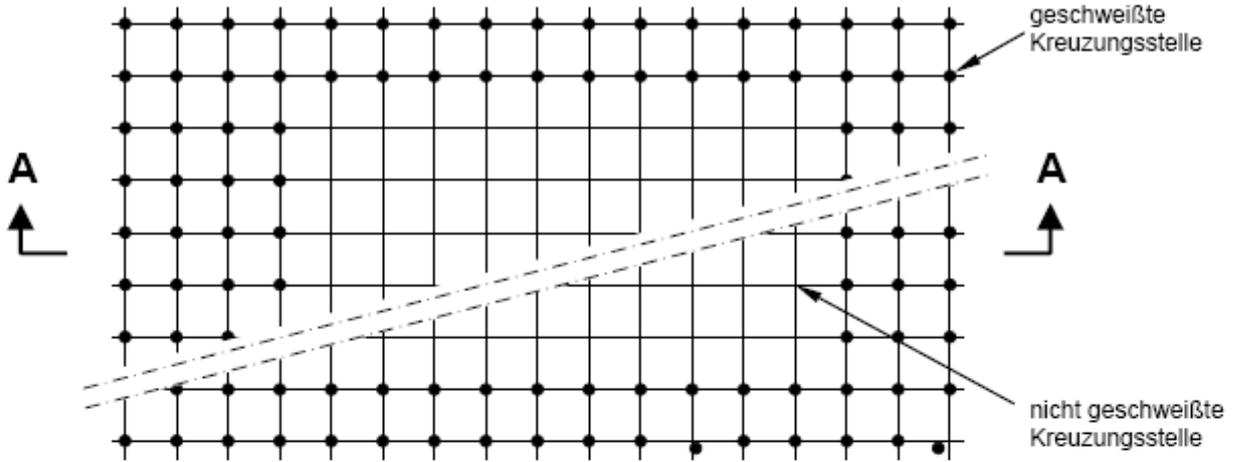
Zulässige Bereiche der Schweißung (hier als Beispiel dargestellt für nicht gestaffelte Bewehrung)
